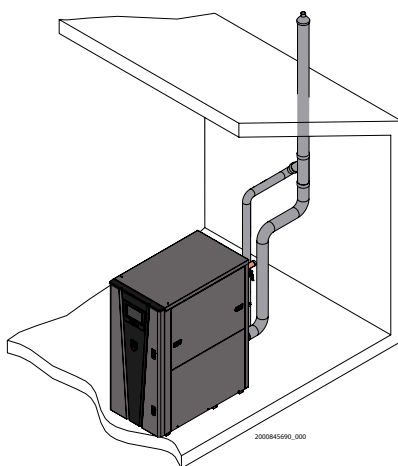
Terminaison verticale concentrique en PVC/CPVC
